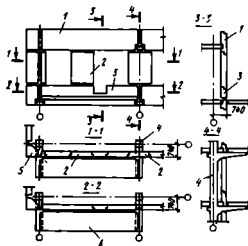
Фрагмент фасада каркасного здания с панелями горизонтальной полосовой разрезки:
